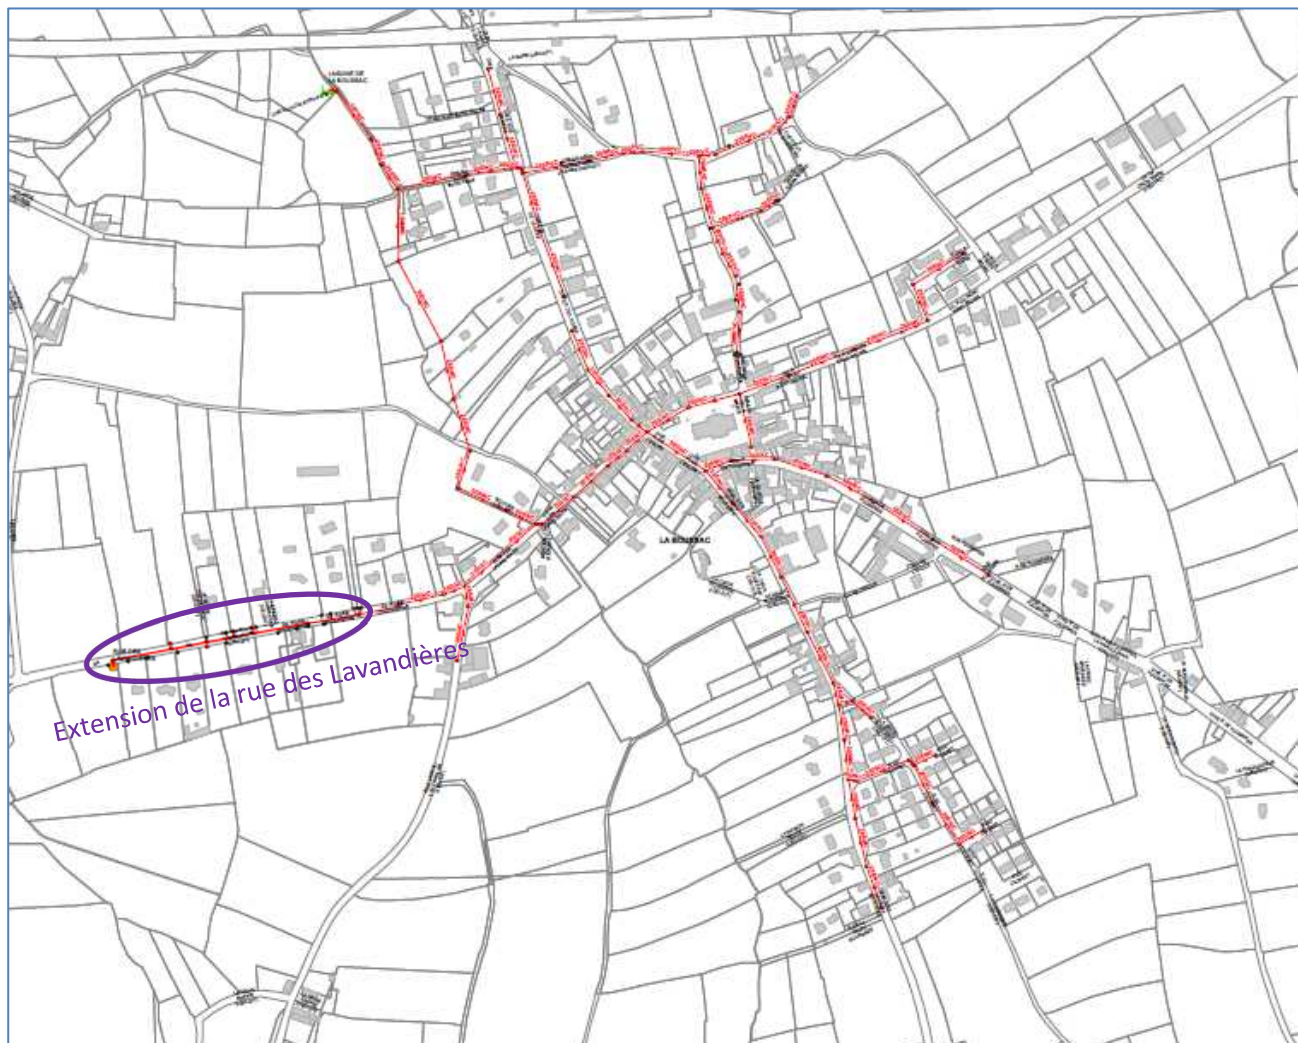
Plan du réseau d'assainissement (source : VEOLIA)
